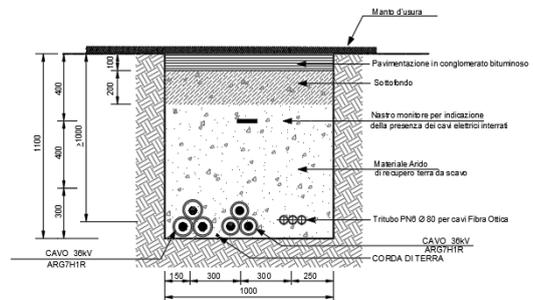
Tipico modalità di posa cavidotto a 36 kV di collegamento impianto FV - Futura SE RTN
